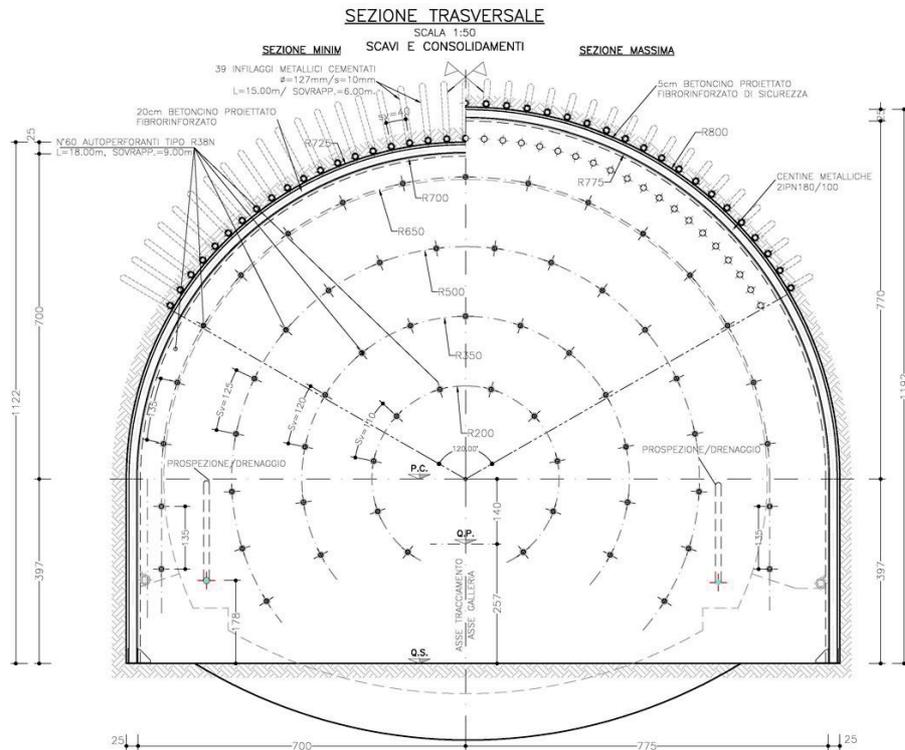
Sezione GN-C1-2 – Sezione di scavo.
